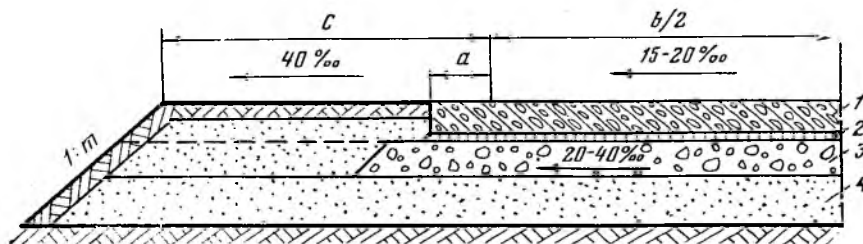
Поперечный профиль жесткой дорожной одежды с монолитным цементобетонным покрытием:
